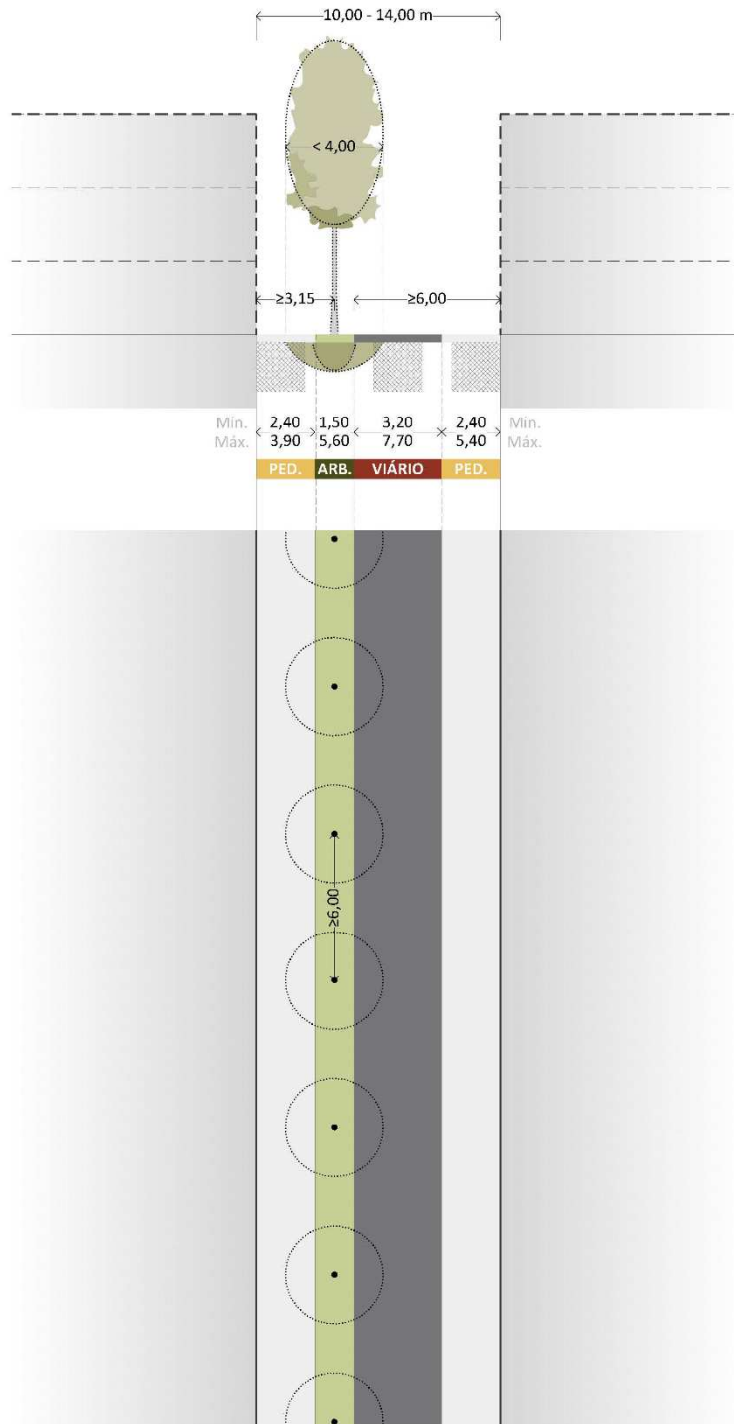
Representação do modelo 1, em corte e em planta.
